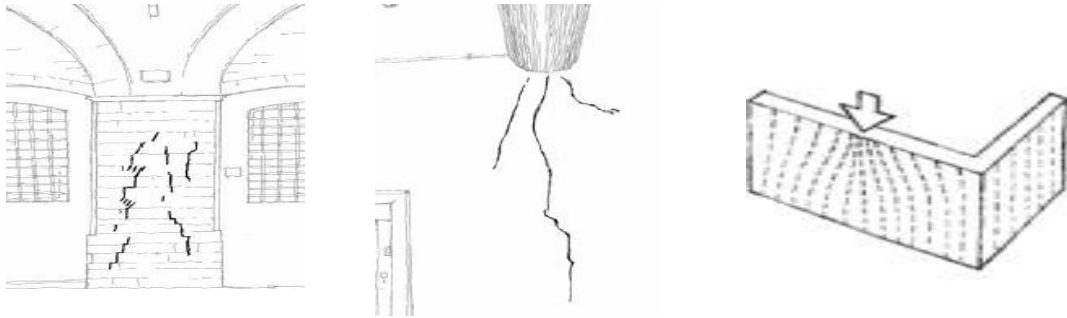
Désordres dus à une charge ponctuelle, cas du poids propre d'une poutre ou poutrelle
